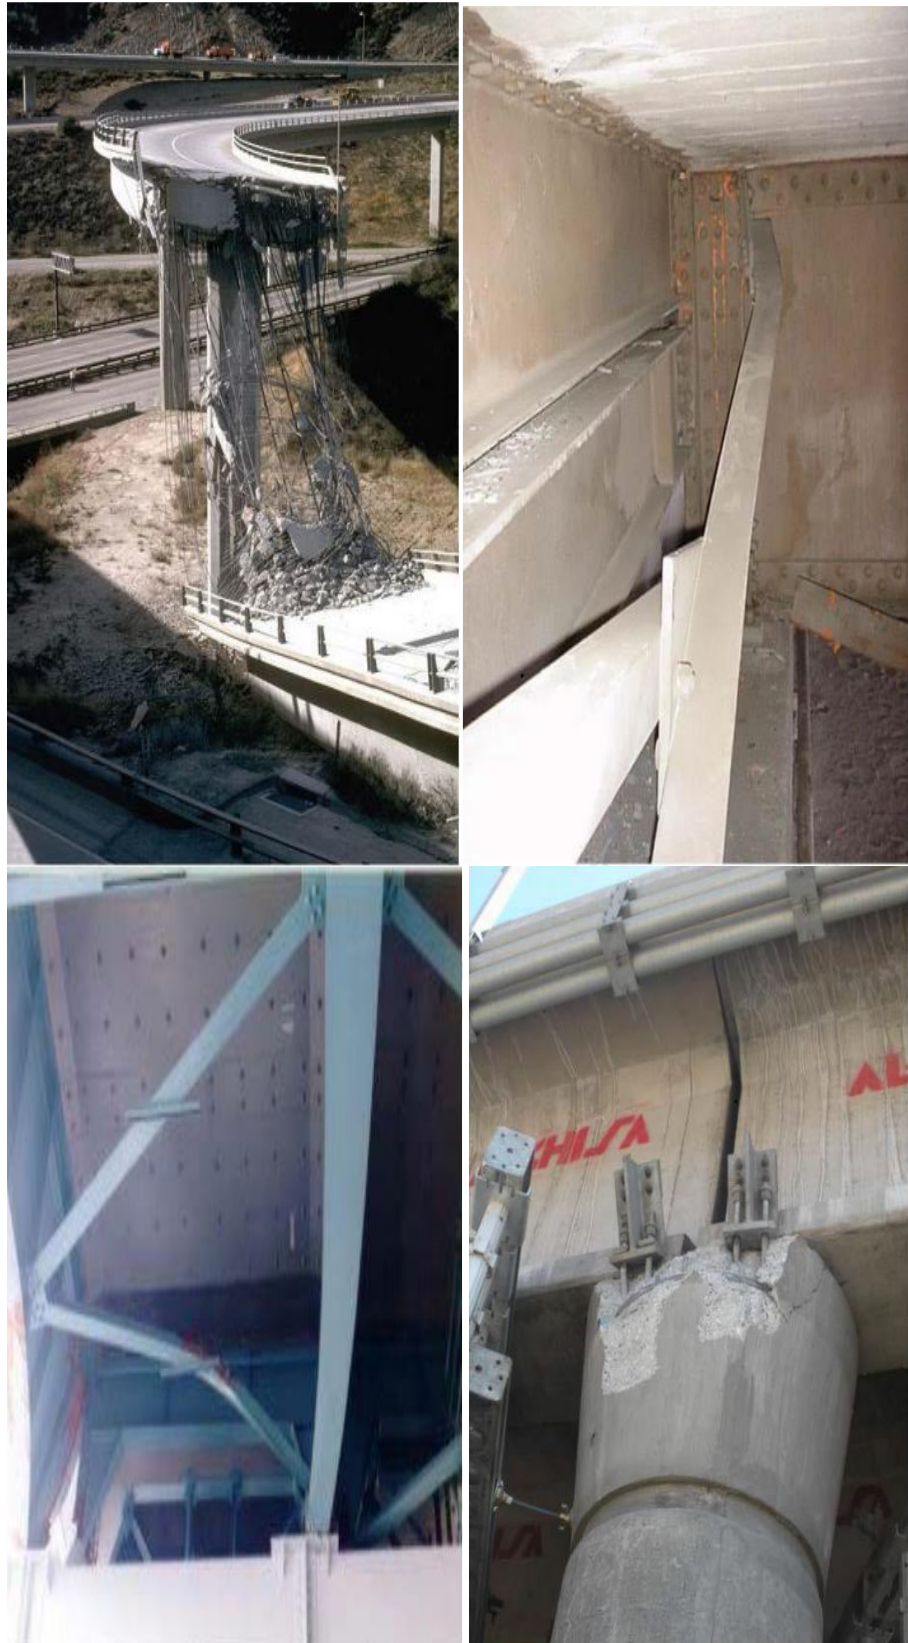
Daños en la columna y muro debido a la falta de detalles dúctiles. San Fernando 1971; Loma Prieta 1989; Taiwán 1991.
